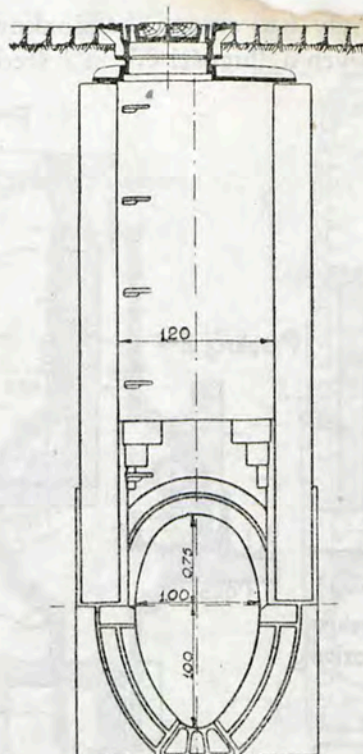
Studzienka żłazowa z betonu ubijanego w wykopie.
